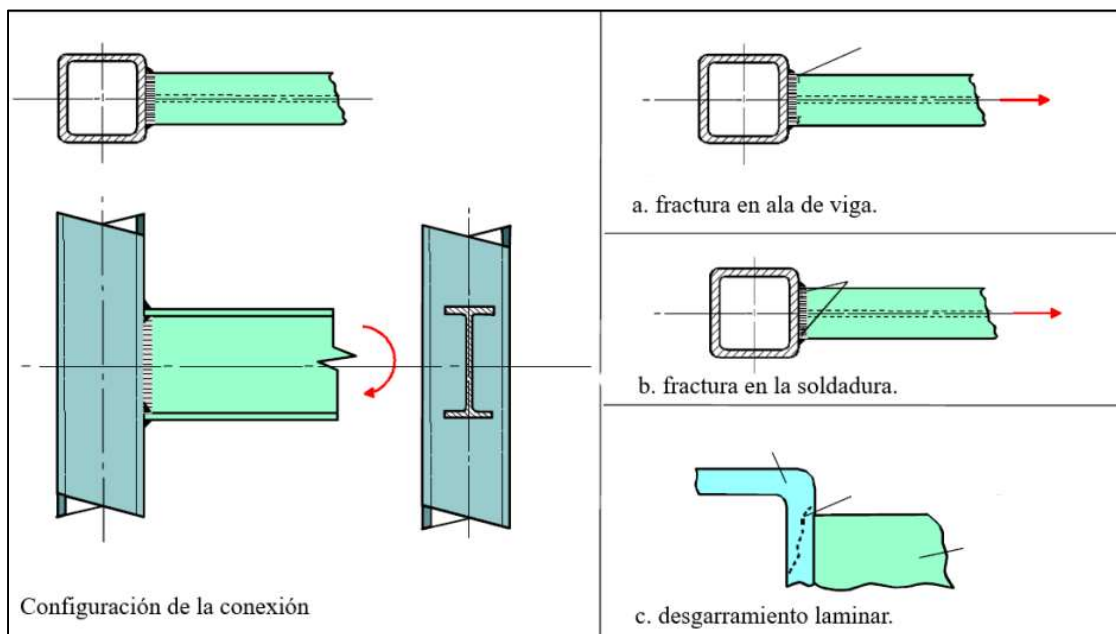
Modos de falla de conexión entre viga I y columna tubular. Fuente: Wardenier, Packer, Zhao, & van der Vegte, 2010, modificado por autora.
